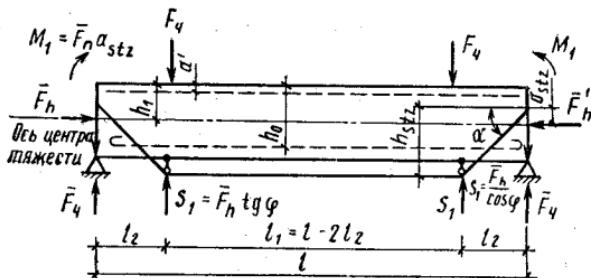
Расчетная схема балки, усиленной шпренгелем
